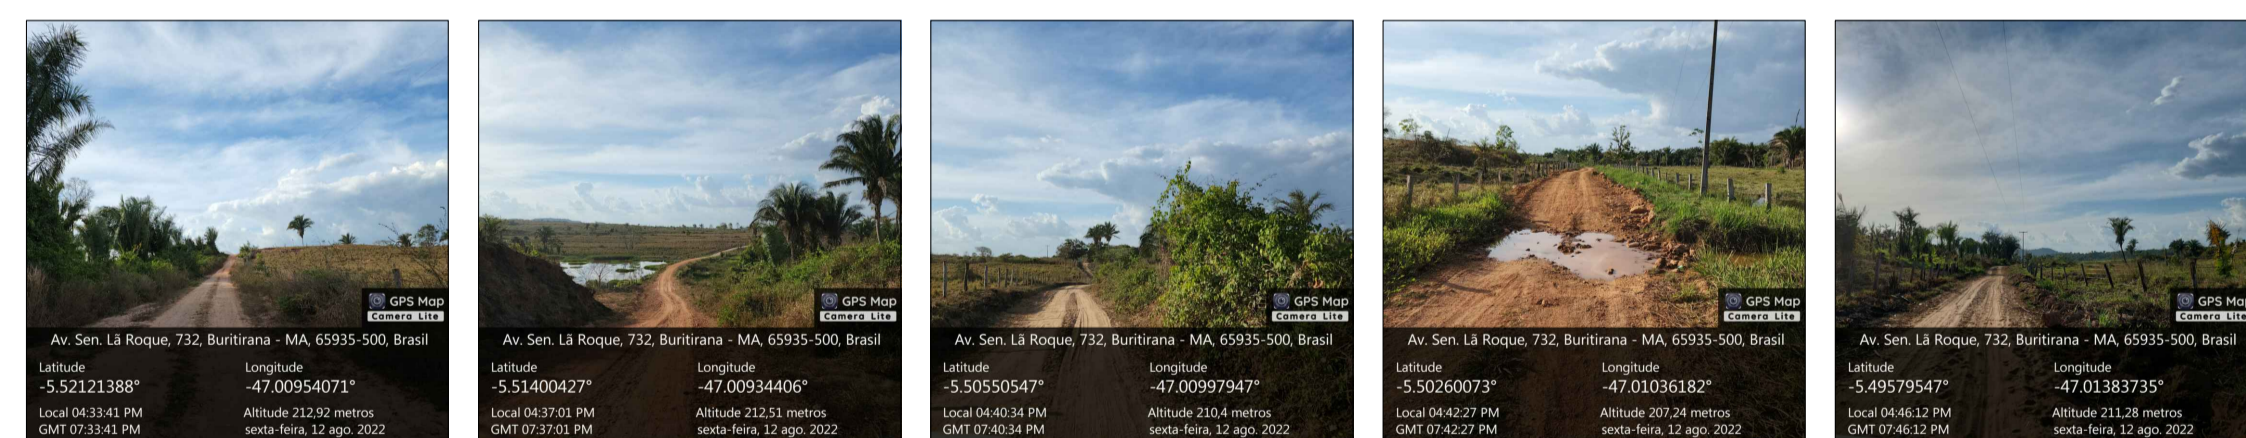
FOTO 12 FOTO 13 FOTO 14 FOTO 15
